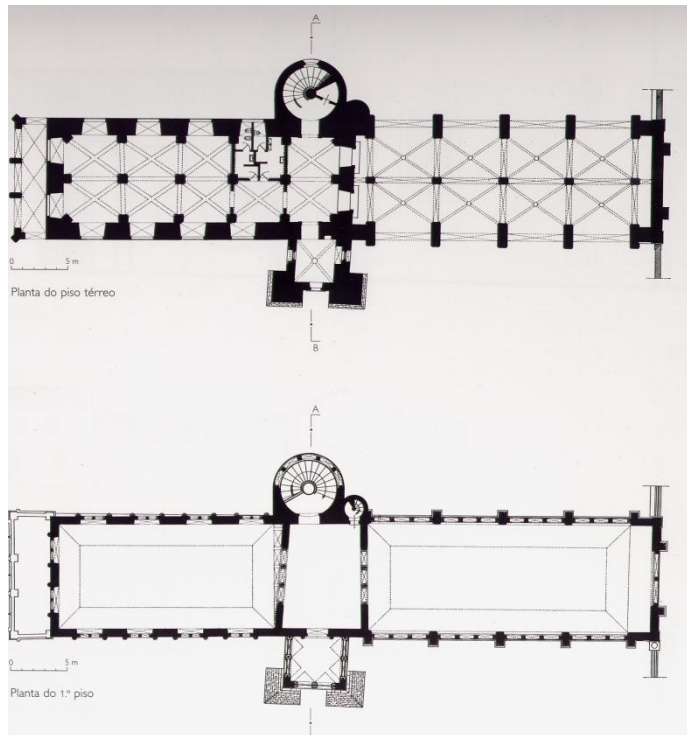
Plantas do piso térreo e do 1º piso da *Galeria das Damas*.
